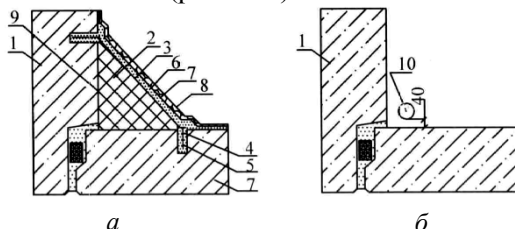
Пример утепления стен: а) изнутри помещения; б) утепление фасада.
